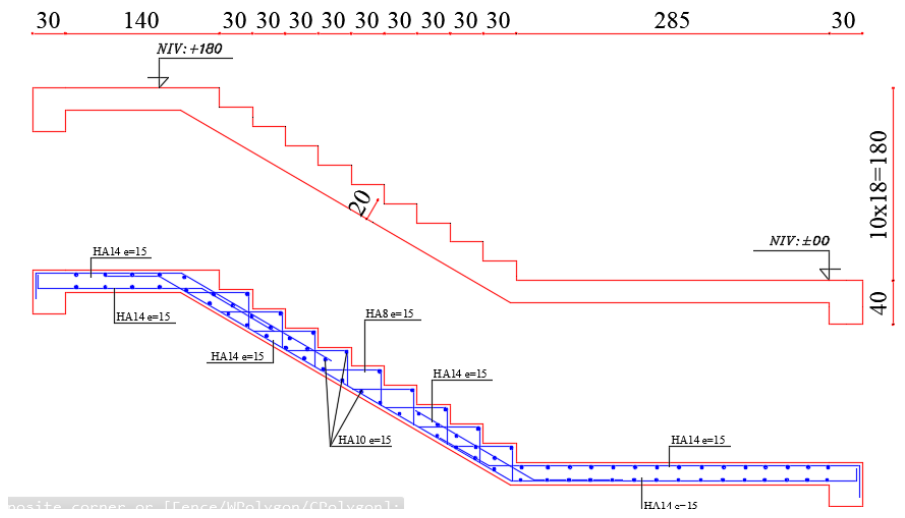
Schéma de ferrailage des escaliers coupe 1-1
